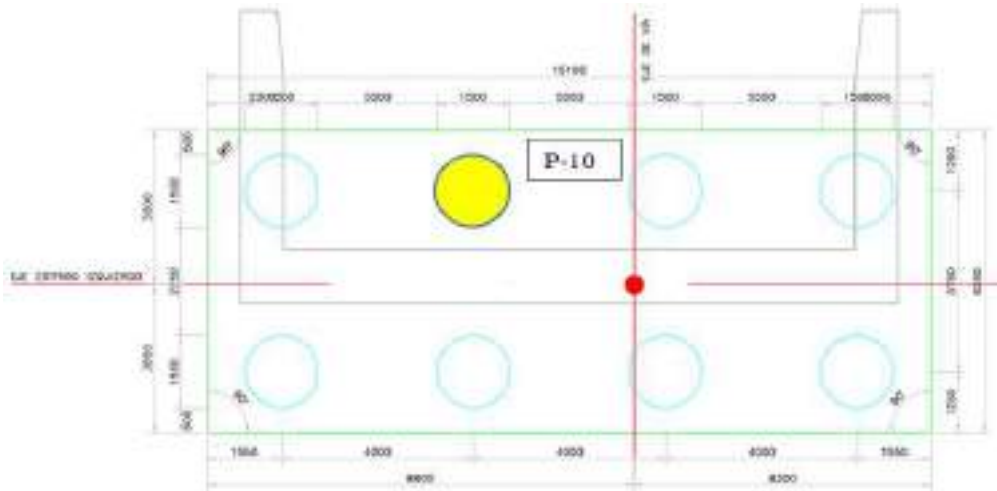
Plano en planta del Estribo Izquierdo – Puente Huambacho.
